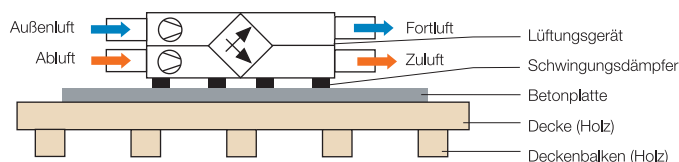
Schallentkoppelte Aufstellung auf einer Holzbalkendecke
